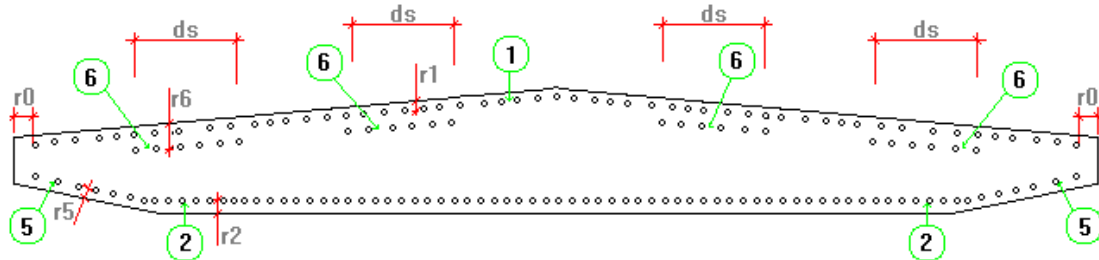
Armadura pasiva de la losa superior de hormigón. Definición de las posiciones de armado y de los recubrimientos para un cajón cerrado.
